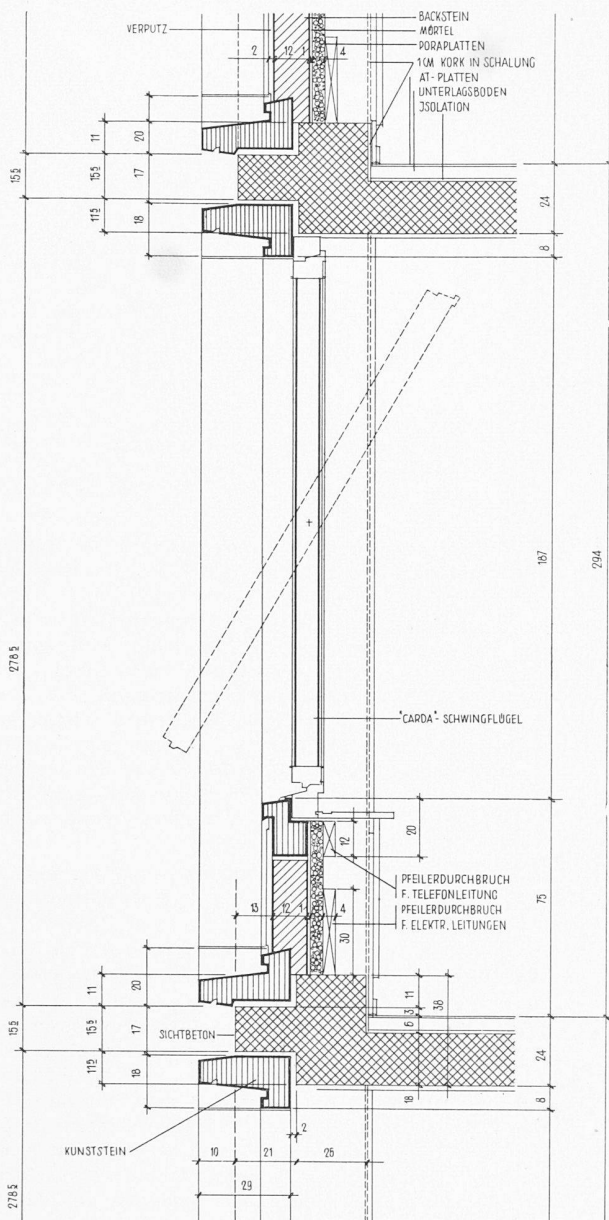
Geschäftshaus in Baden, Aussenwandschnitt, Masstab 1:25
